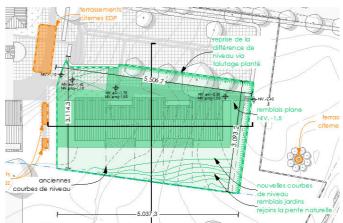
Extrait de la planche 24-a schématisant les remblais
